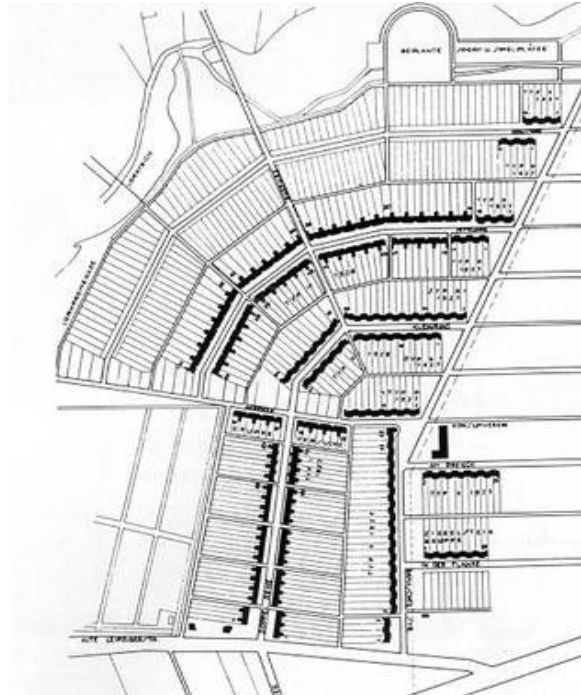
PROJETO DO LOTEAMENTO DE TORTEN, DESSAU 1926-28
